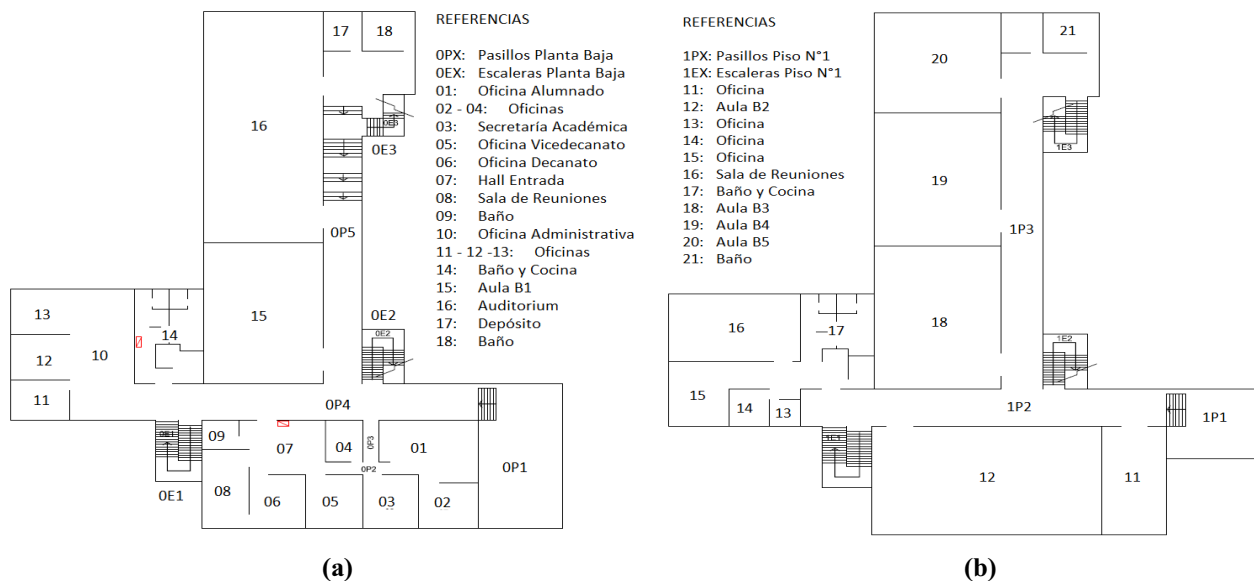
Planos esquemáticos de los sectores seleccionados. (a) Planta baja. (b) Primer piso.
